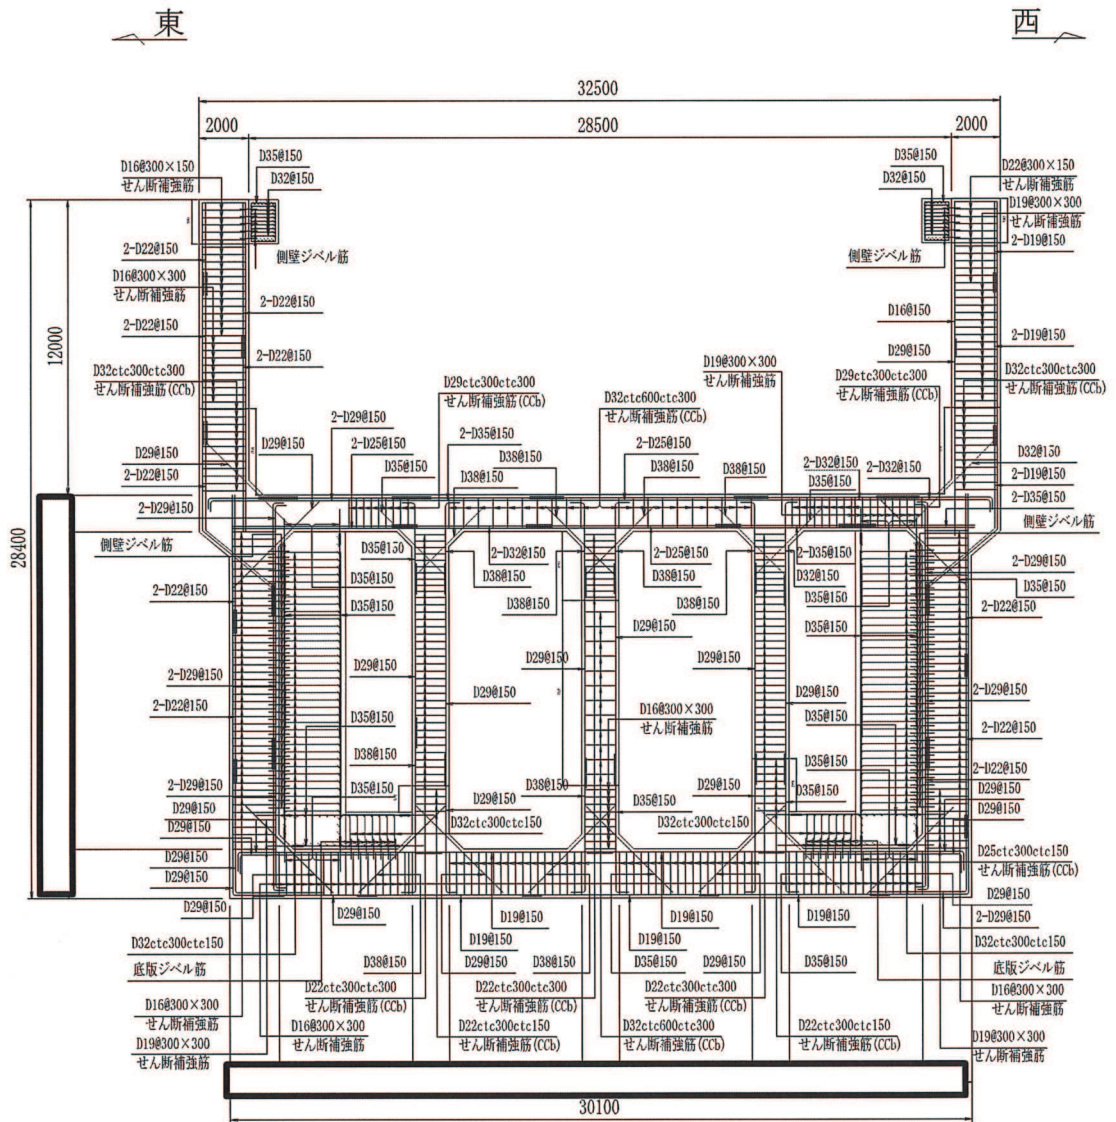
海水ポンプ室概略配筋図 (B-B 断面, 東西)
